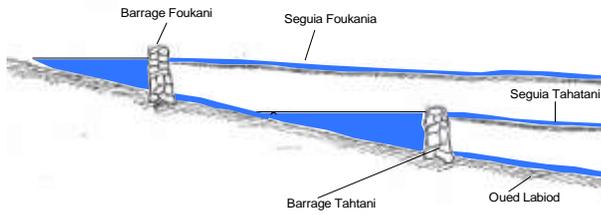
Schéma d'une coupe longitudinale de l'oued Labiod (Schéma Remini, 2018)
